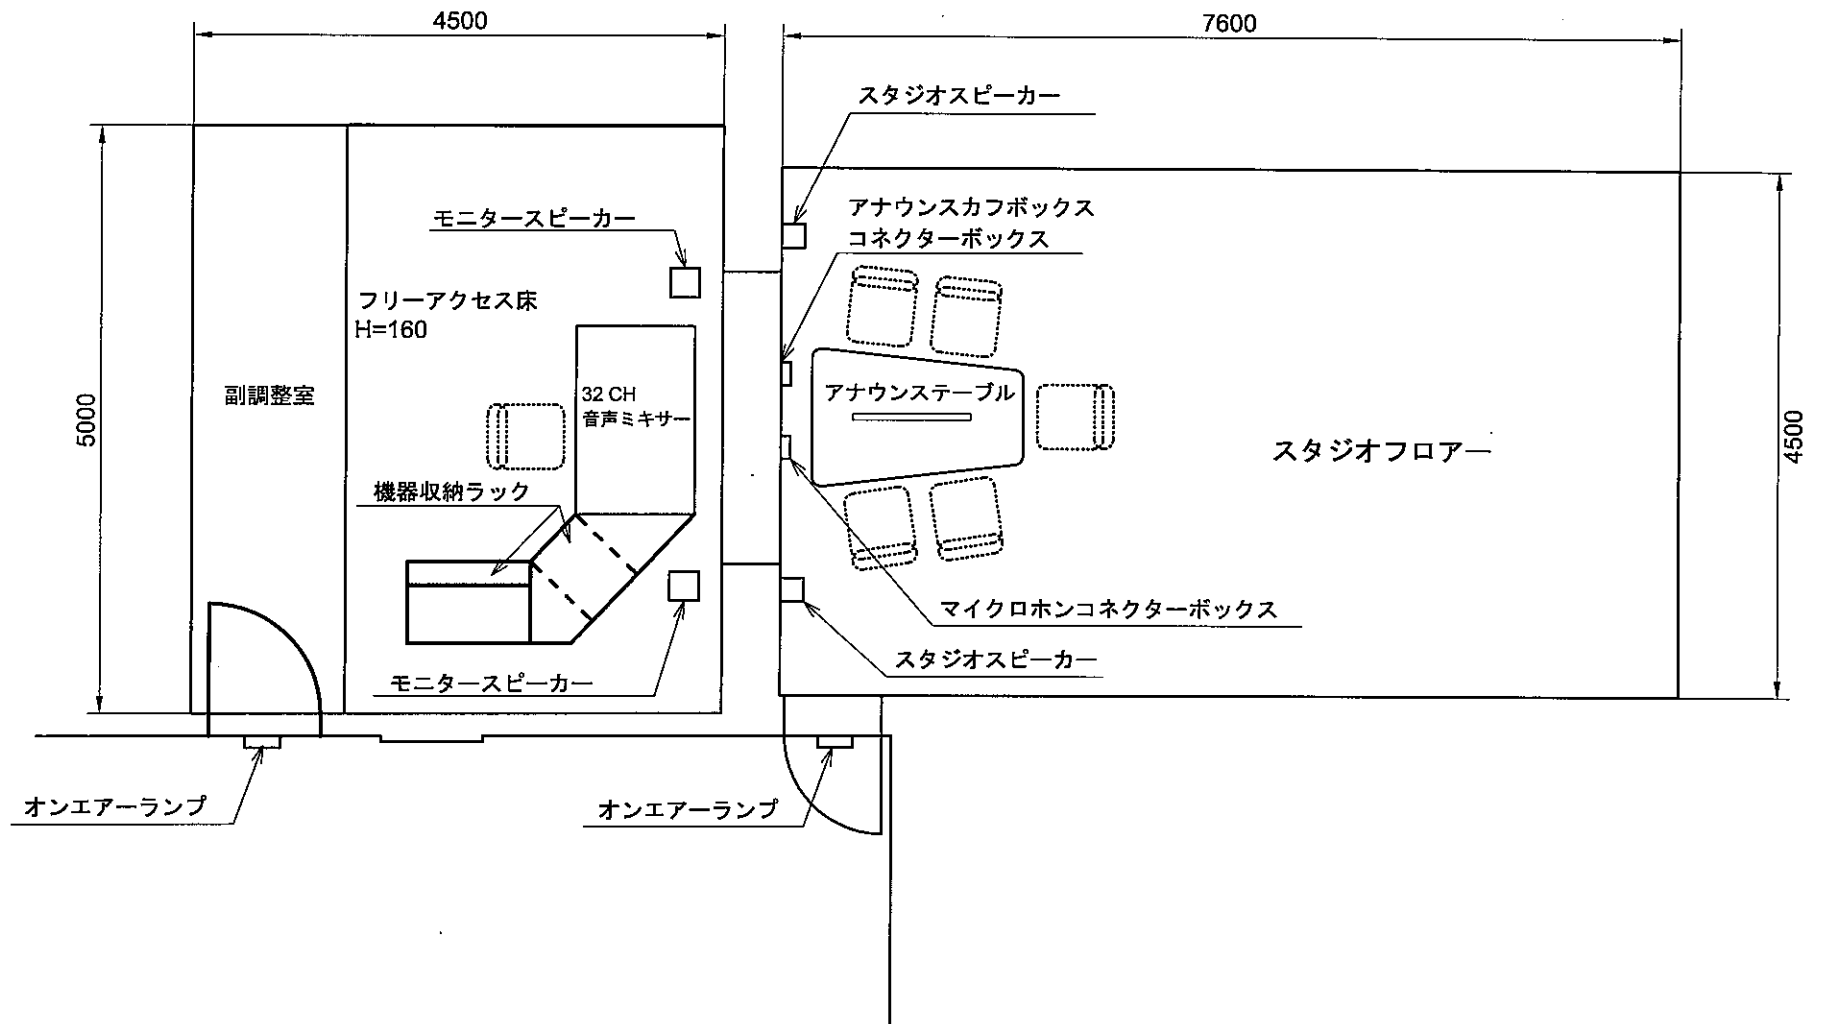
スタジオ機器配置図 (ヤウンデ放送局)
